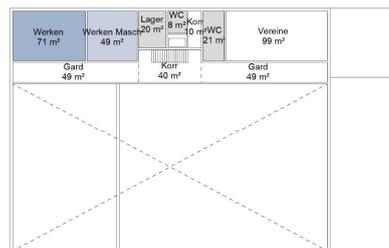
2. Obergeschoss Turnhalle, Variante «violett»
